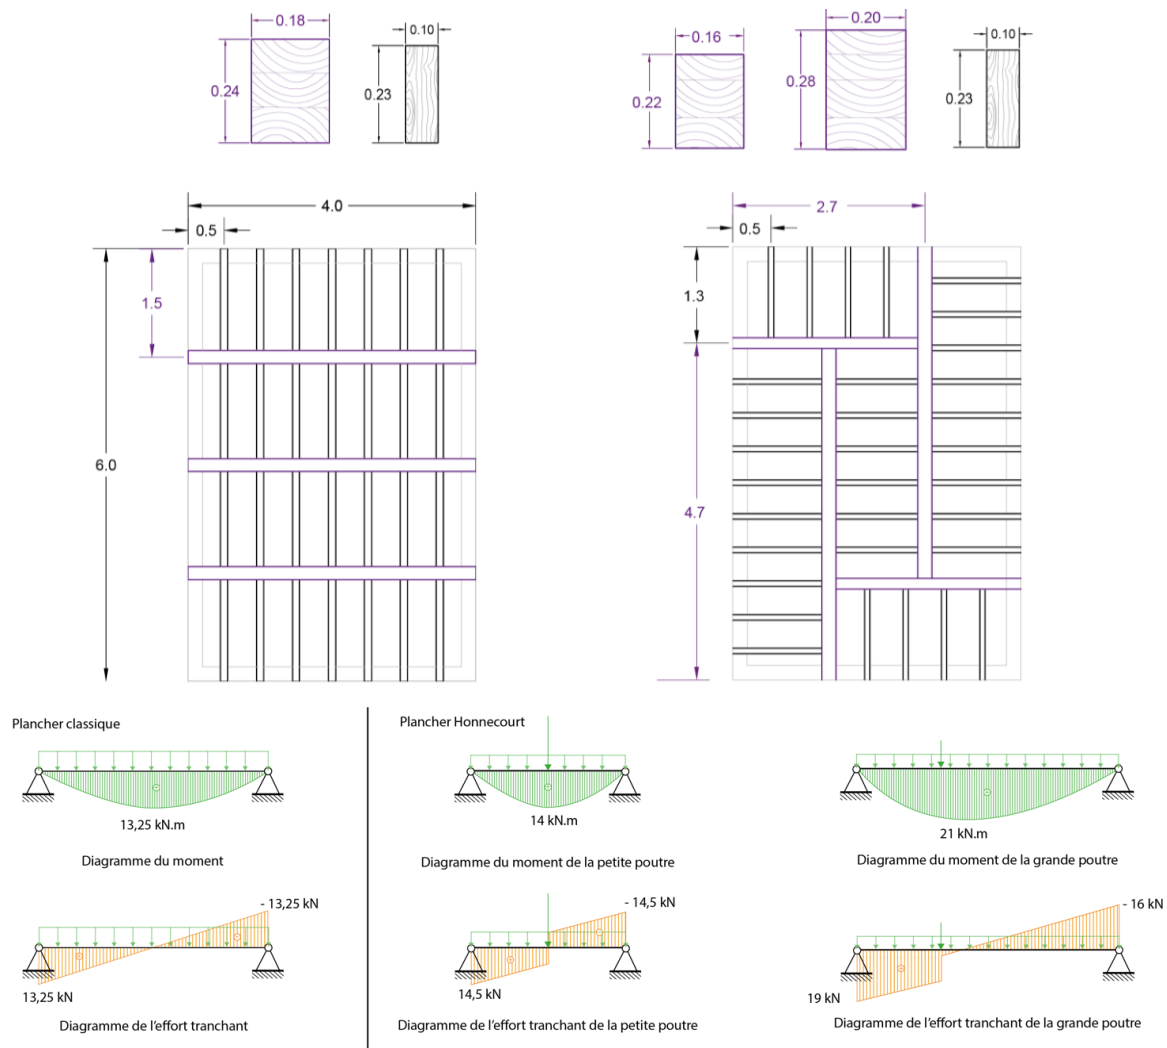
Plan et cotes des planchers et des poutres, diagrammes du moment fléchissant et de l’effort tranchant dans les poutres principales du plancher classique et Honnecourt, et dimensions des éléments calculées [Merle M. – CTA EE1].
